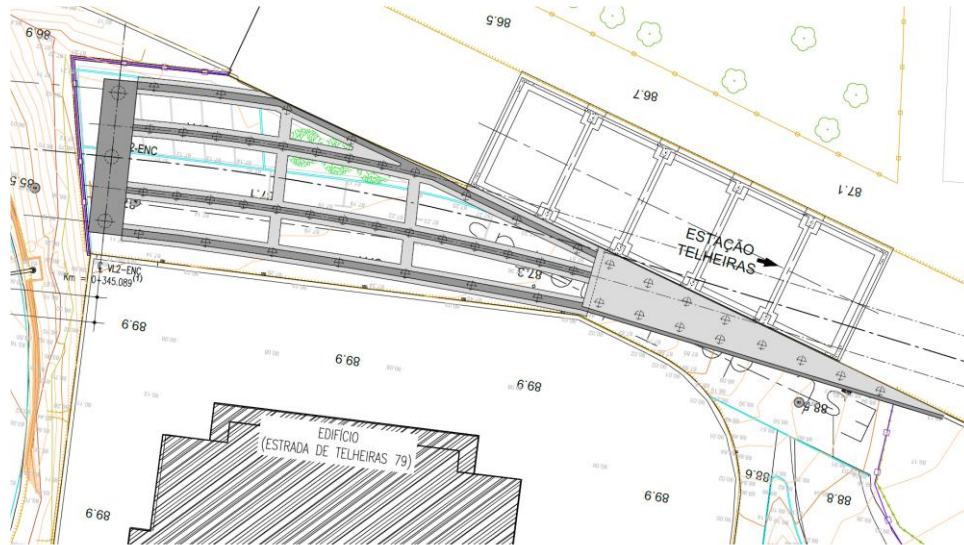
Planta – Encontro Poente e Edifício 79- 79F
